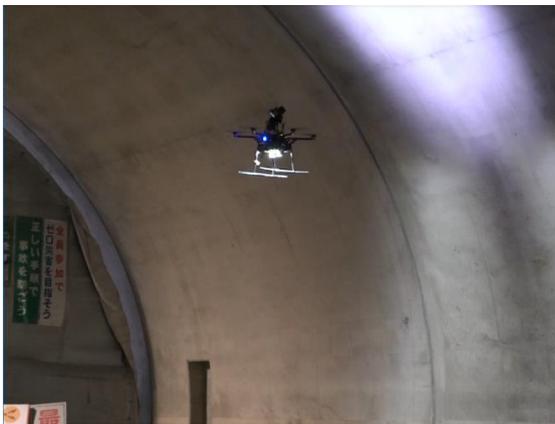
本実験状況 (覆工コンクリート面で実施・自動撮影中)
